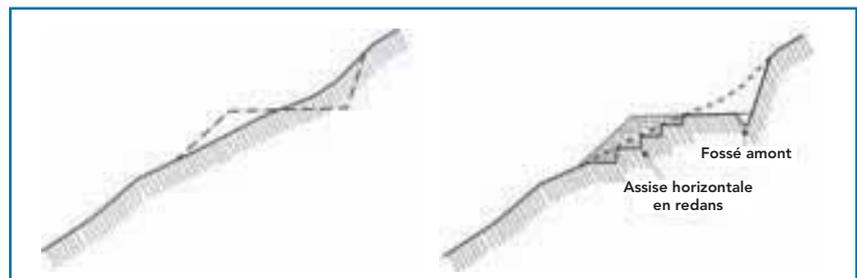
coupe schématique d'un terrassement en déblai - remblai
